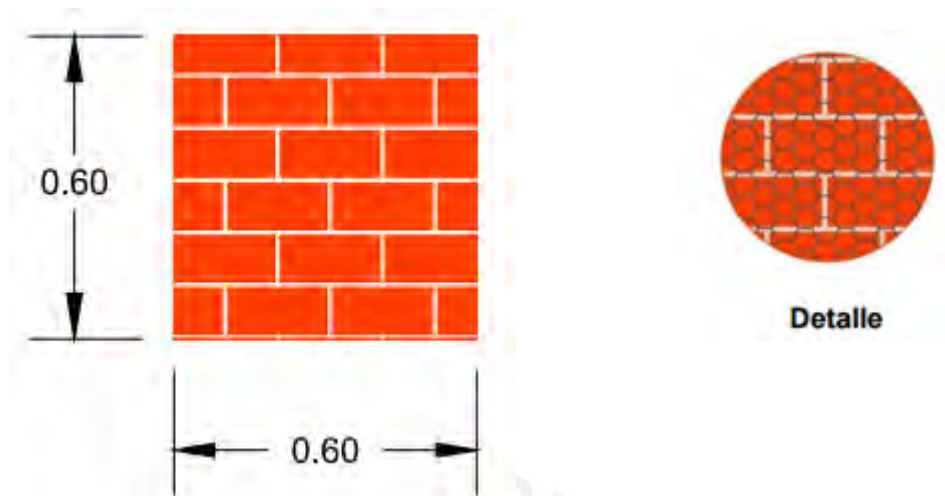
Murete reforzado con malla para tarrajeo (Tipo M2)
